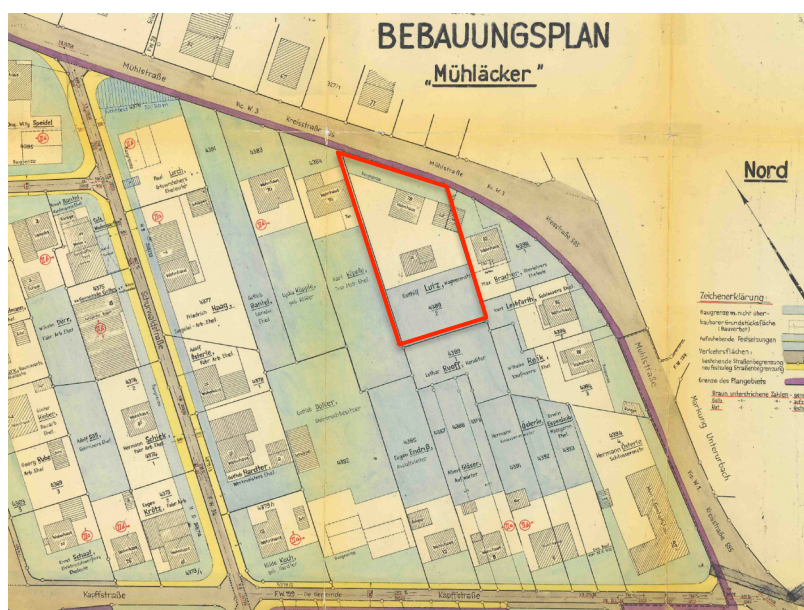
Ausschnitt von Bebauungsplan Nr. 77, Quelle: Gemeinde Urbach
